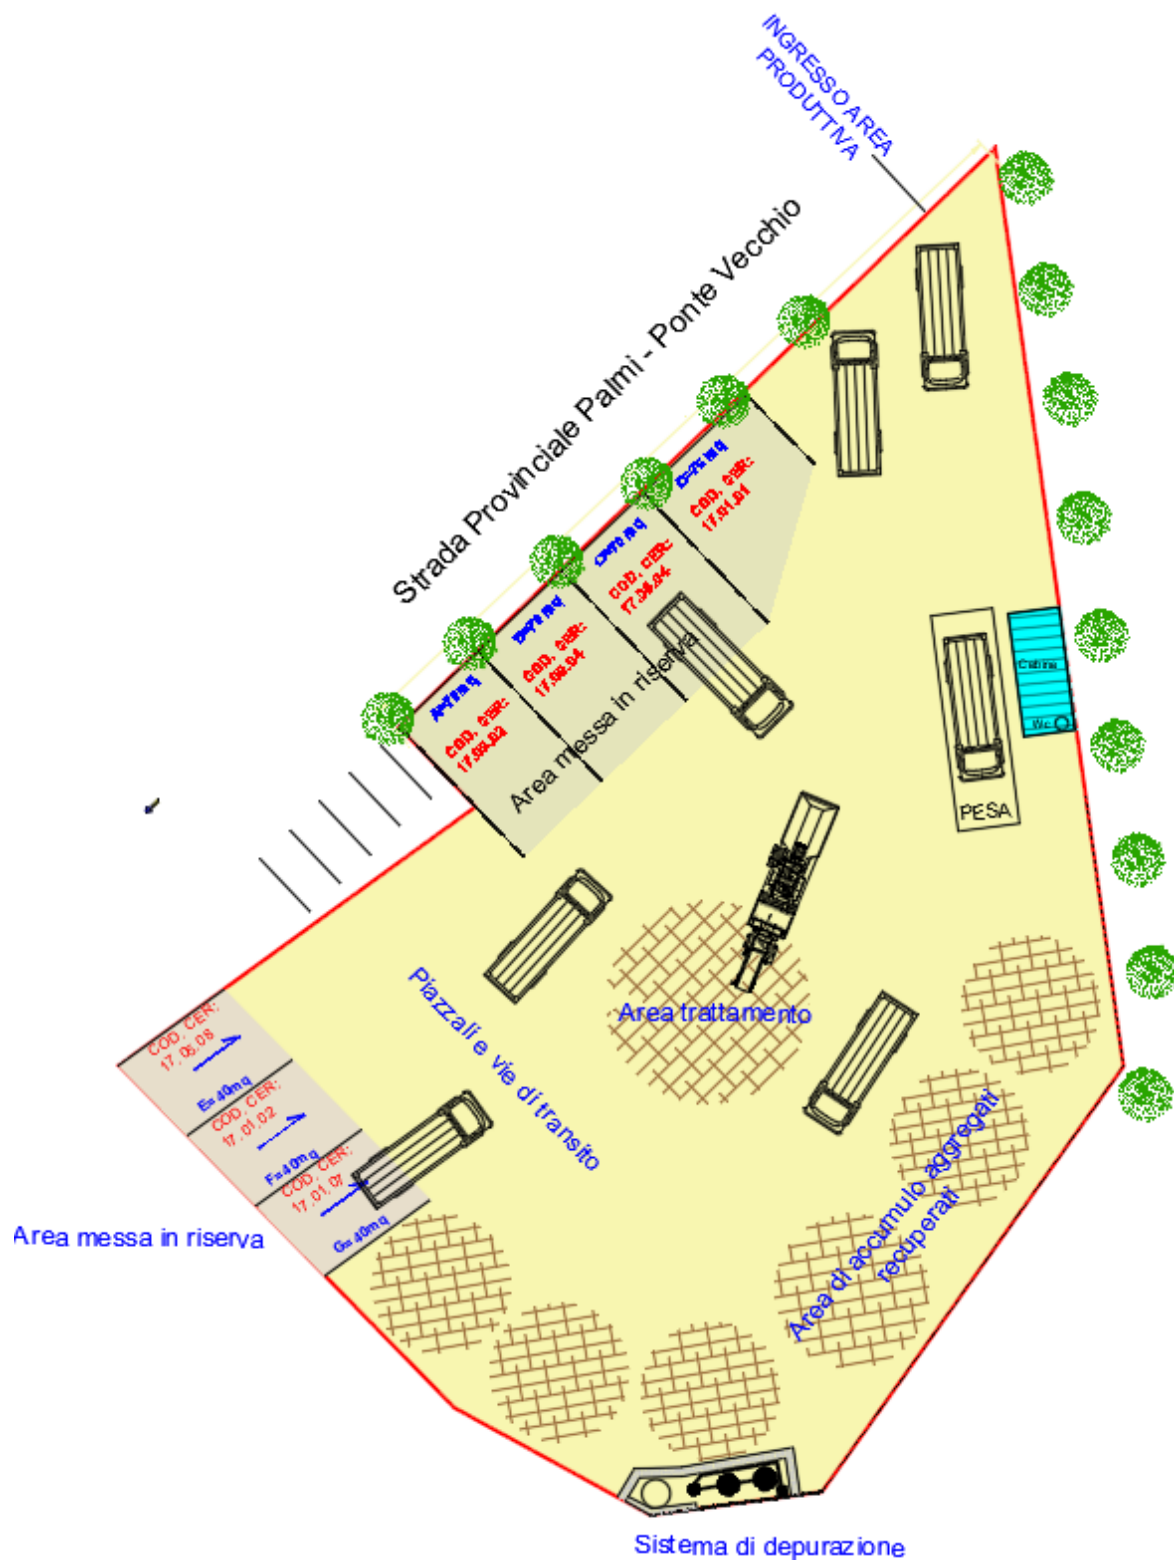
Pianta stabilimento produttivo già autorizzato in procedure semplificate dalla Città Metropolitana di Reggio Calabria Dlgs 152/2006 art. 214-216,; lay-out modificato per adattarlo alle nuove esigenze di progetto.
